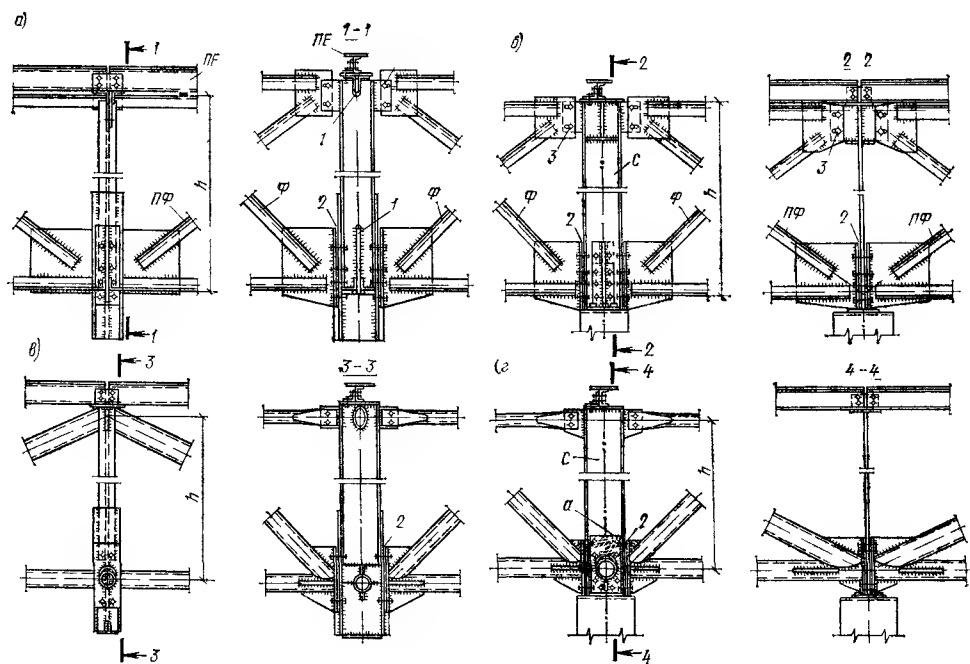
Узлы сопряжения стропильных и подстропильных ферм
